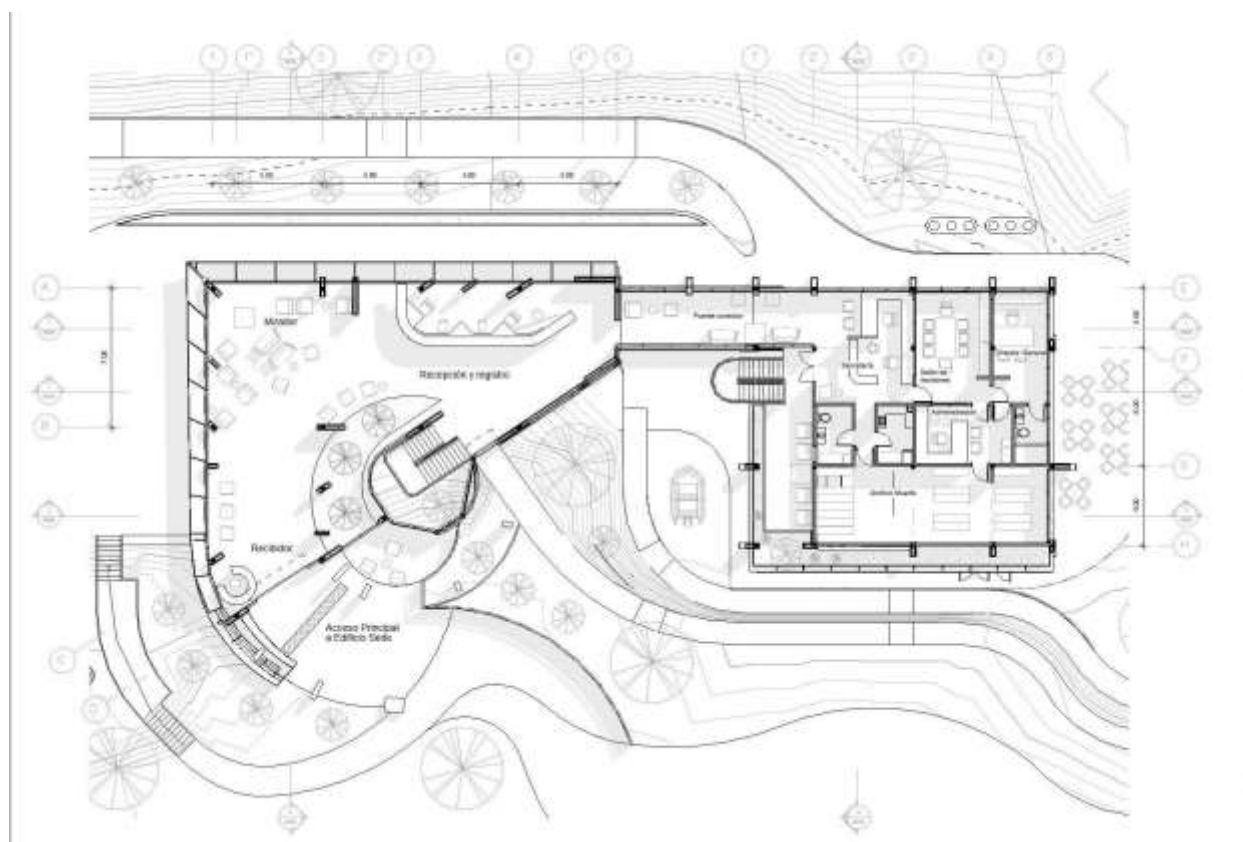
Planta Baja amoblada del Edificio Sede.
